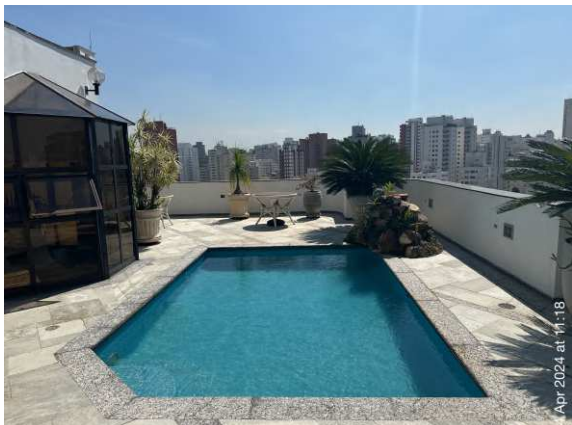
Vista da piscina pertencente ao apartamento n.º 121.
